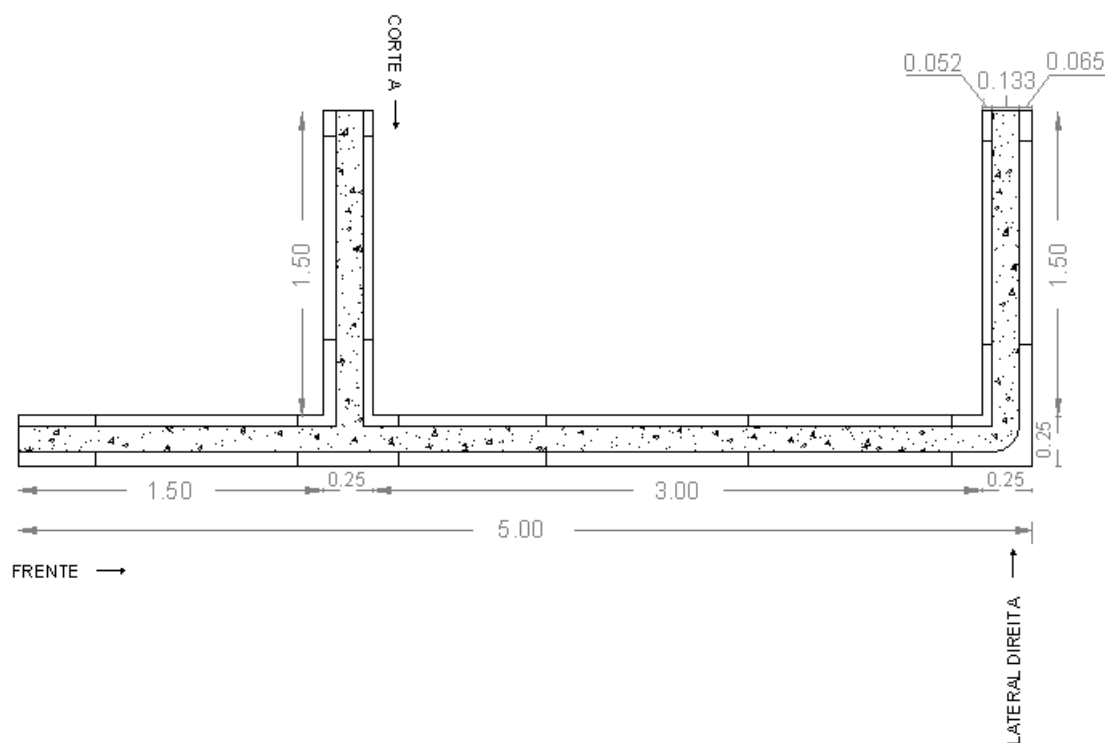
Planta do módulo em cofragens modulares em EPS.
